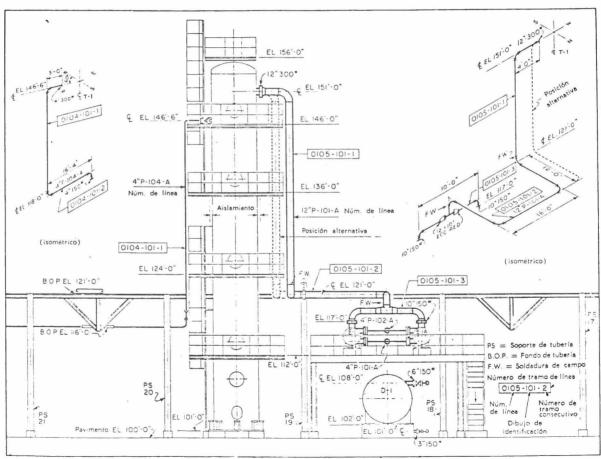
DIBUJO ISOMETRICO DE TUBERIAS.
